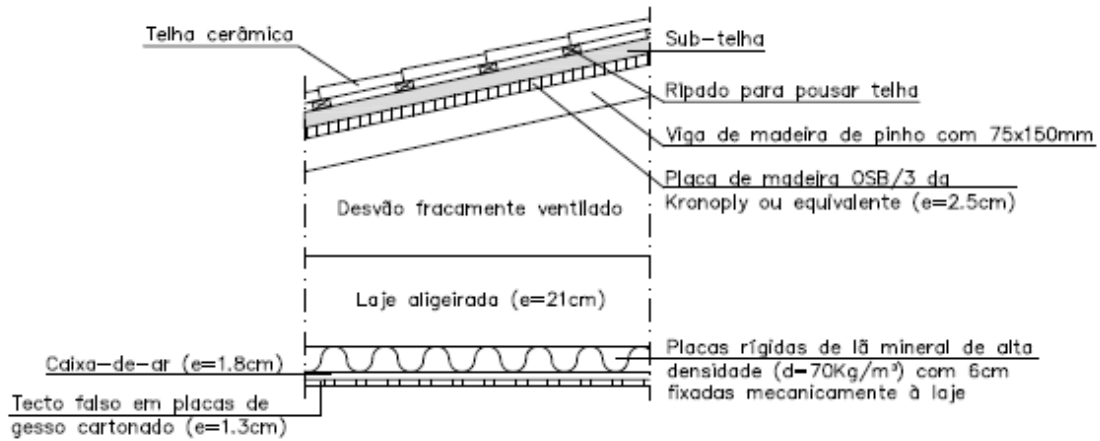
Pormenor da cobertura e teto do 3º piso [17]
